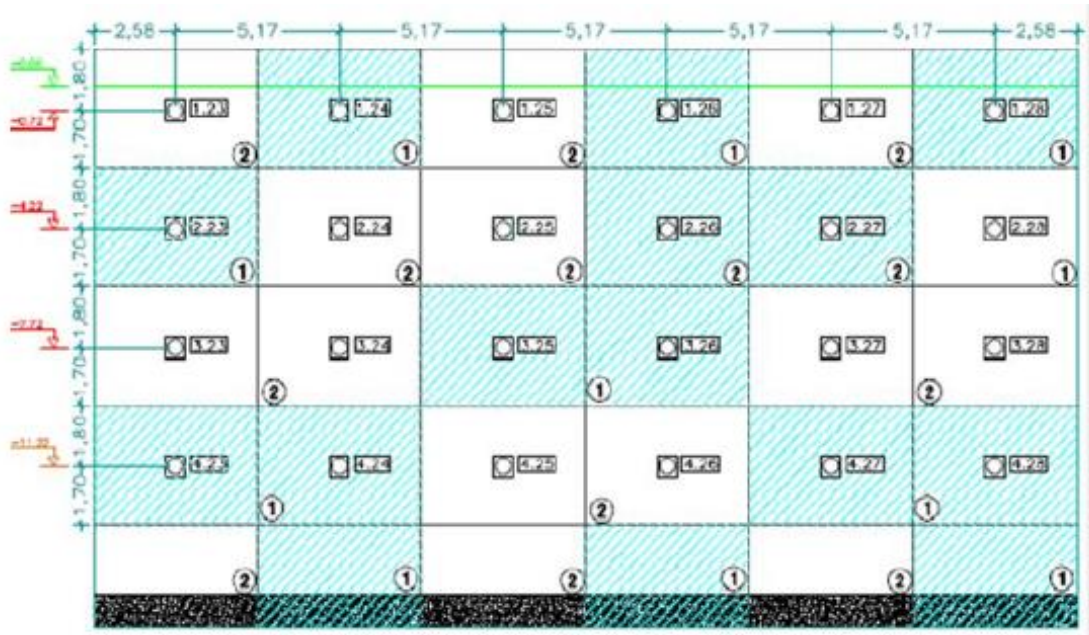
Orden de construcción de muros por niveles (ejemplo)
